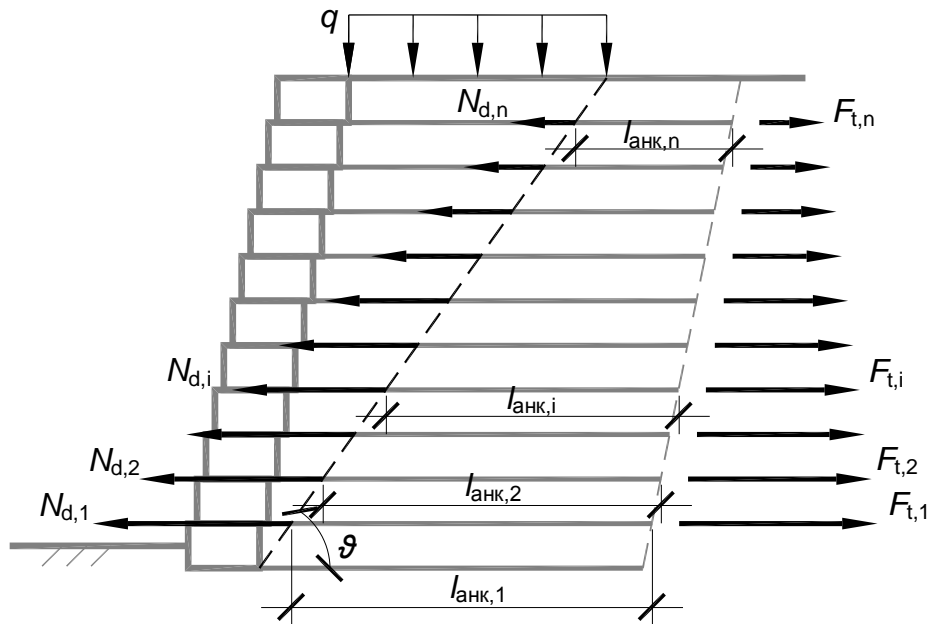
Расчетная схема к проверке на выдергивание армирующих элементов
